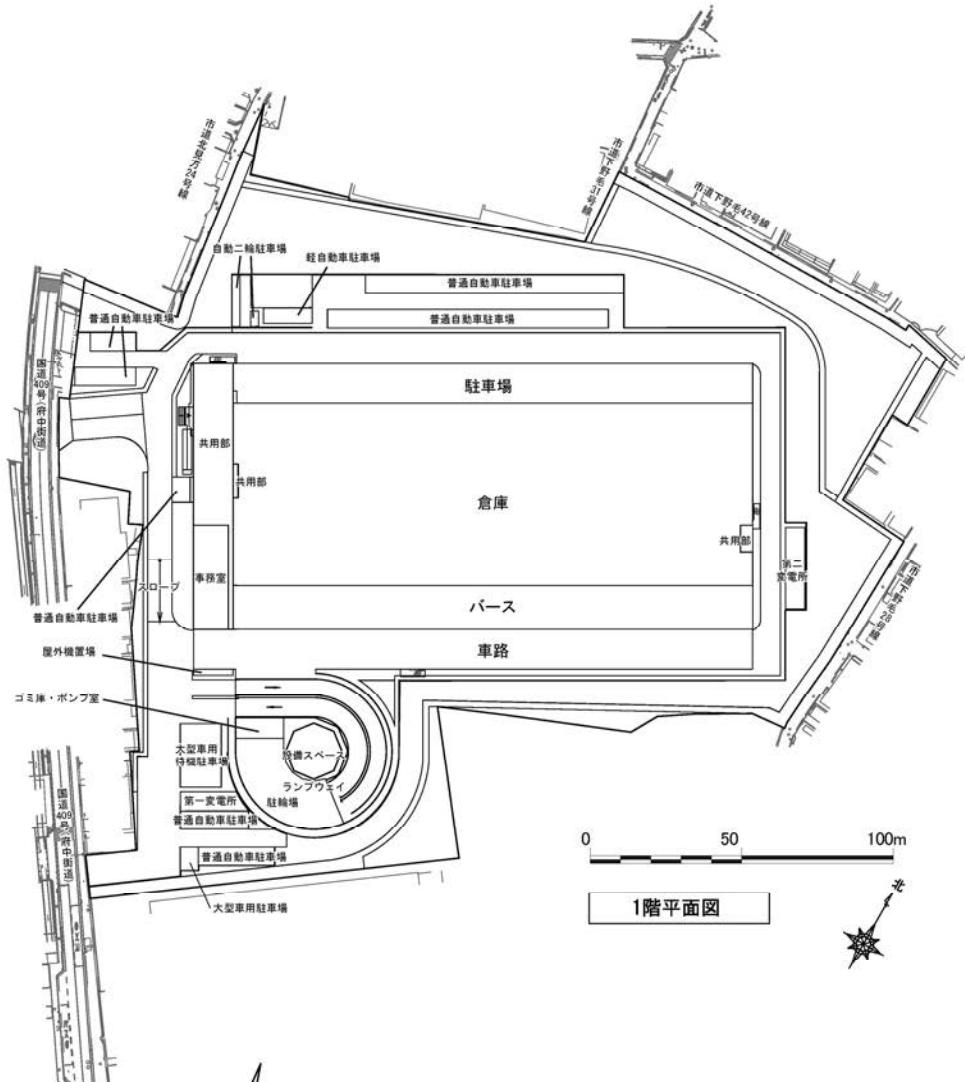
(1) 計画建物平面図 (1、2～4 階)
